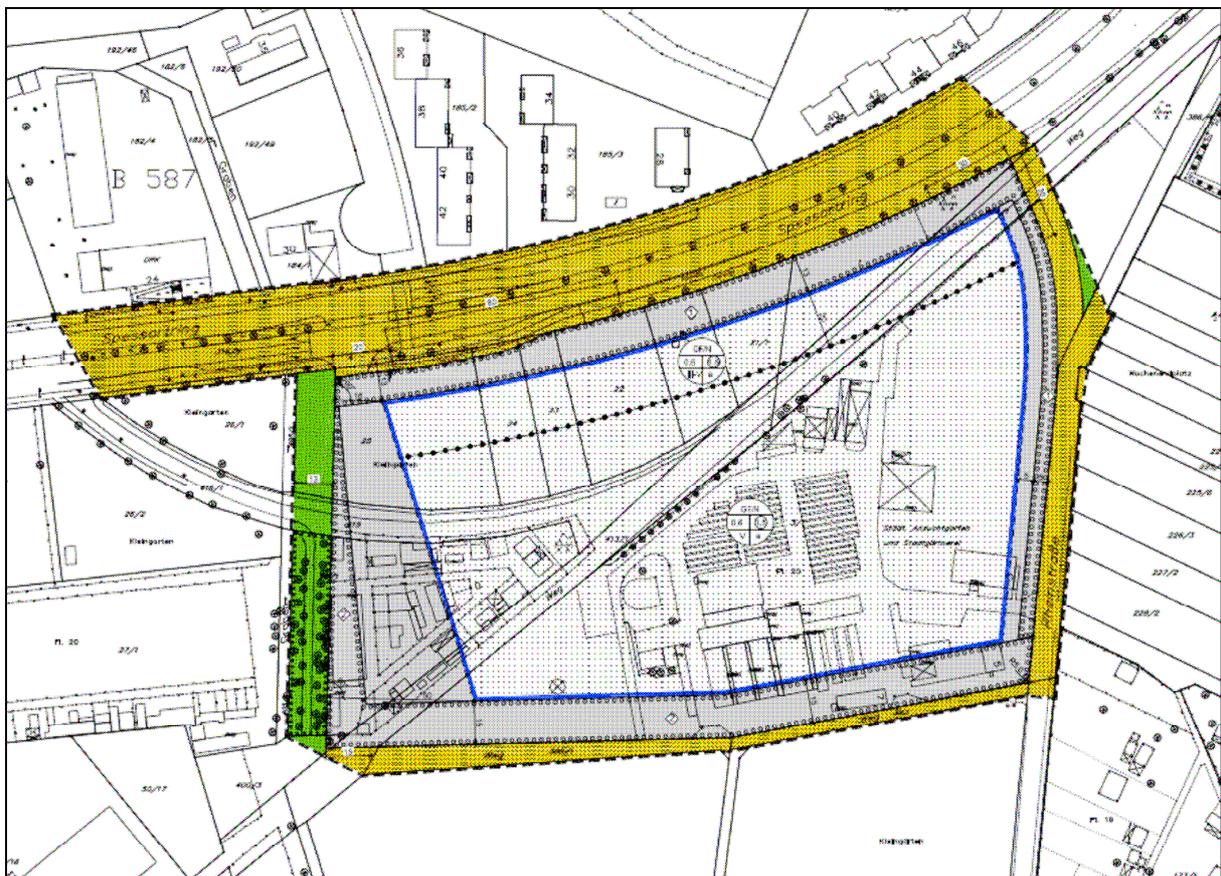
Bebauungsplan Nr. 628 „Spessartring / Rheinstraße“
